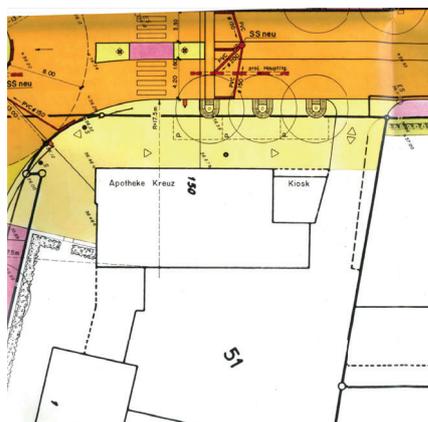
Ausschnitt aus dem bestehenden Strassenplan im Bereich der Kreuz-Apotheke
